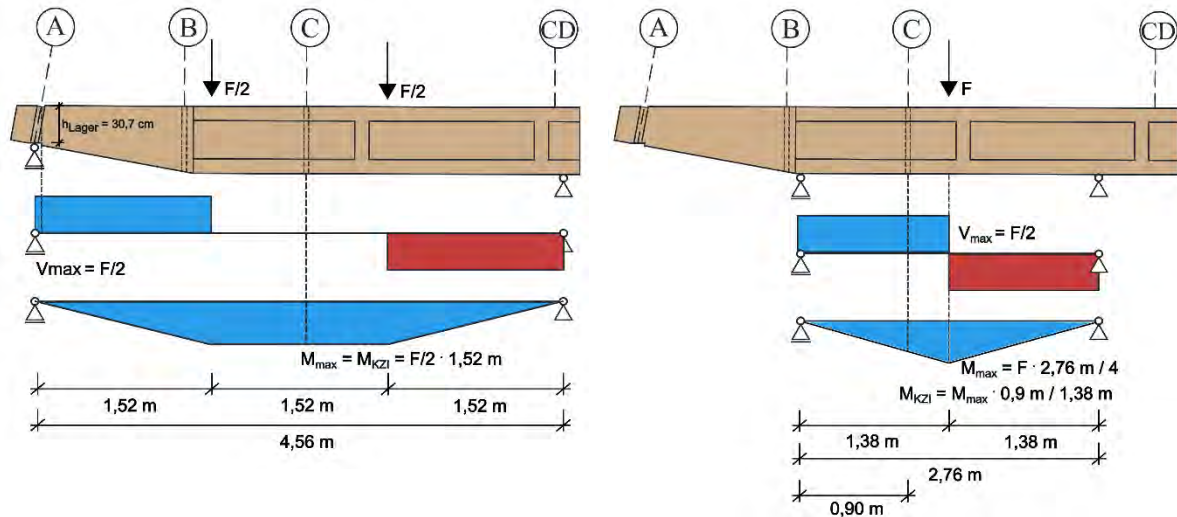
Übersichtsplan Träger Bauteilprüfung und Prüfkörperbezeichnung
